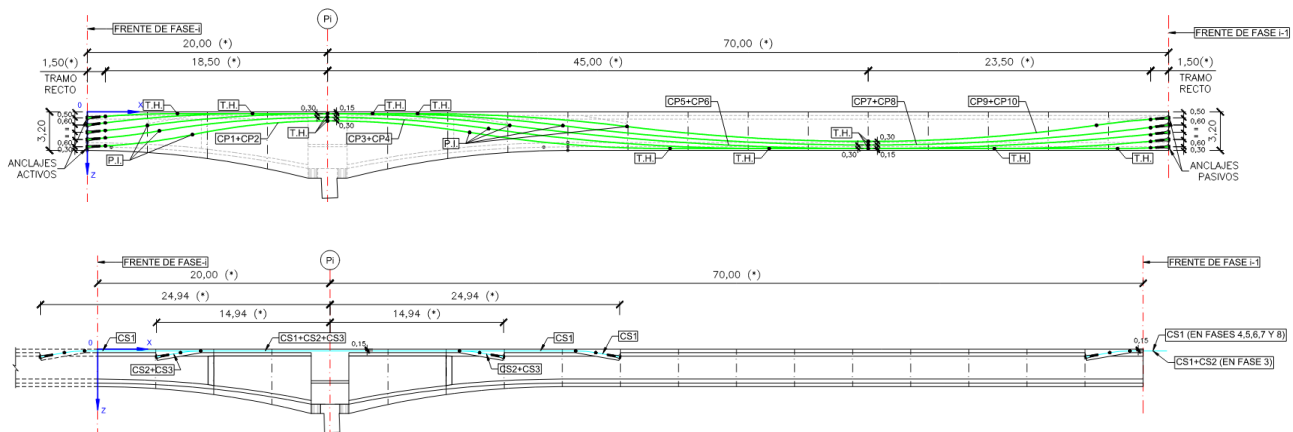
Configuración en alzado del pretensado interior de uno de los vanos tipo
